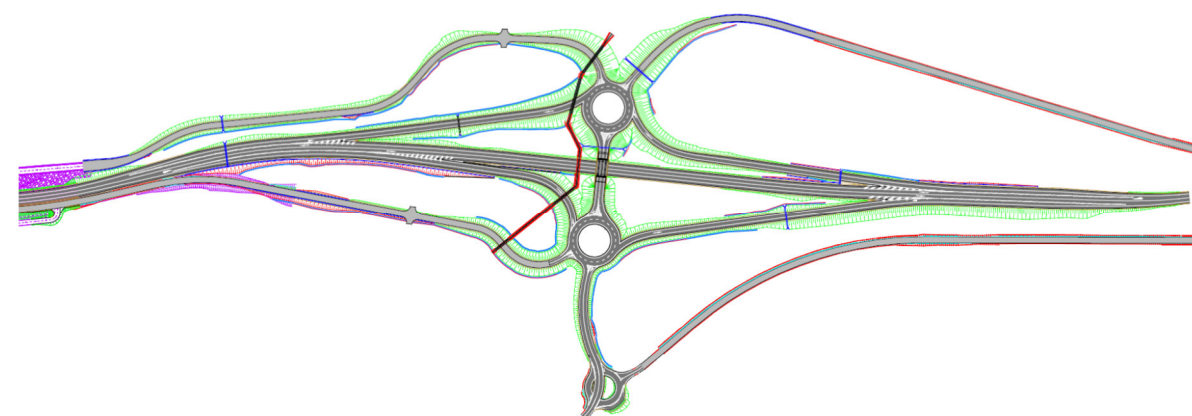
Detalle de planta de trazado del Proyecto Complementario Nº1 de la Obra: "Acondicionamiento de la carretera. Tramo: Tordera-Maçanet de la Selva", de Clave: 12-GI-3741
